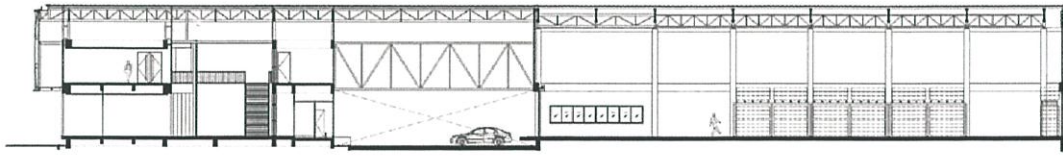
Elevation 3 TAK Sale Office & Warehouse
